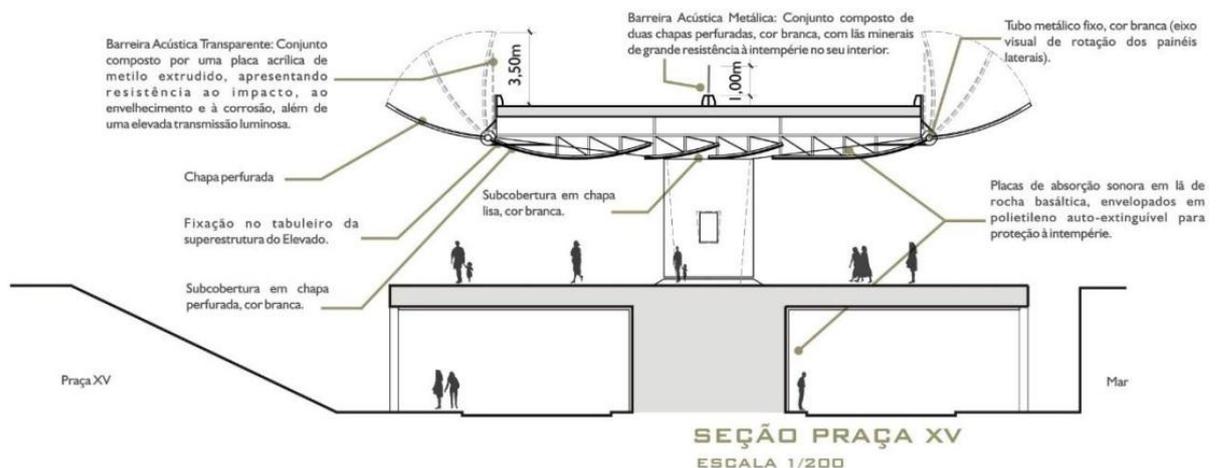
(b) – Corte transversal do viaduto da Perimetral no trecho da Praça XV.
